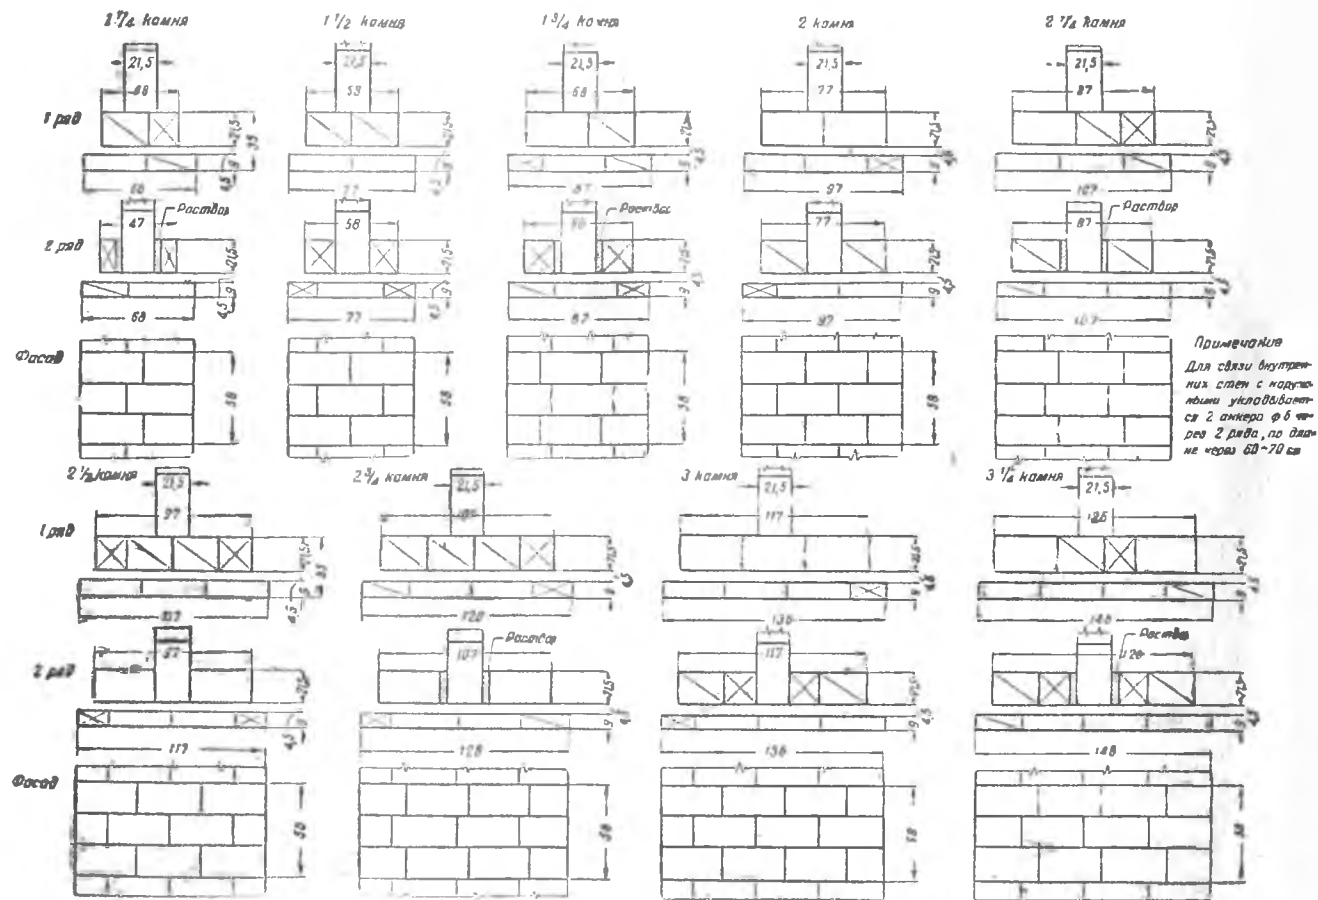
Стены с воздушным прослойком из разных блоков. Кладка простенков с примыкающими внутренними стенами
